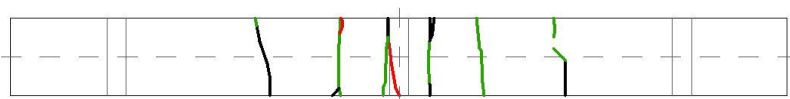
Catalogación de las grietas en la viga sin muesca tras el ciclo 5. Caras A, C y D.
